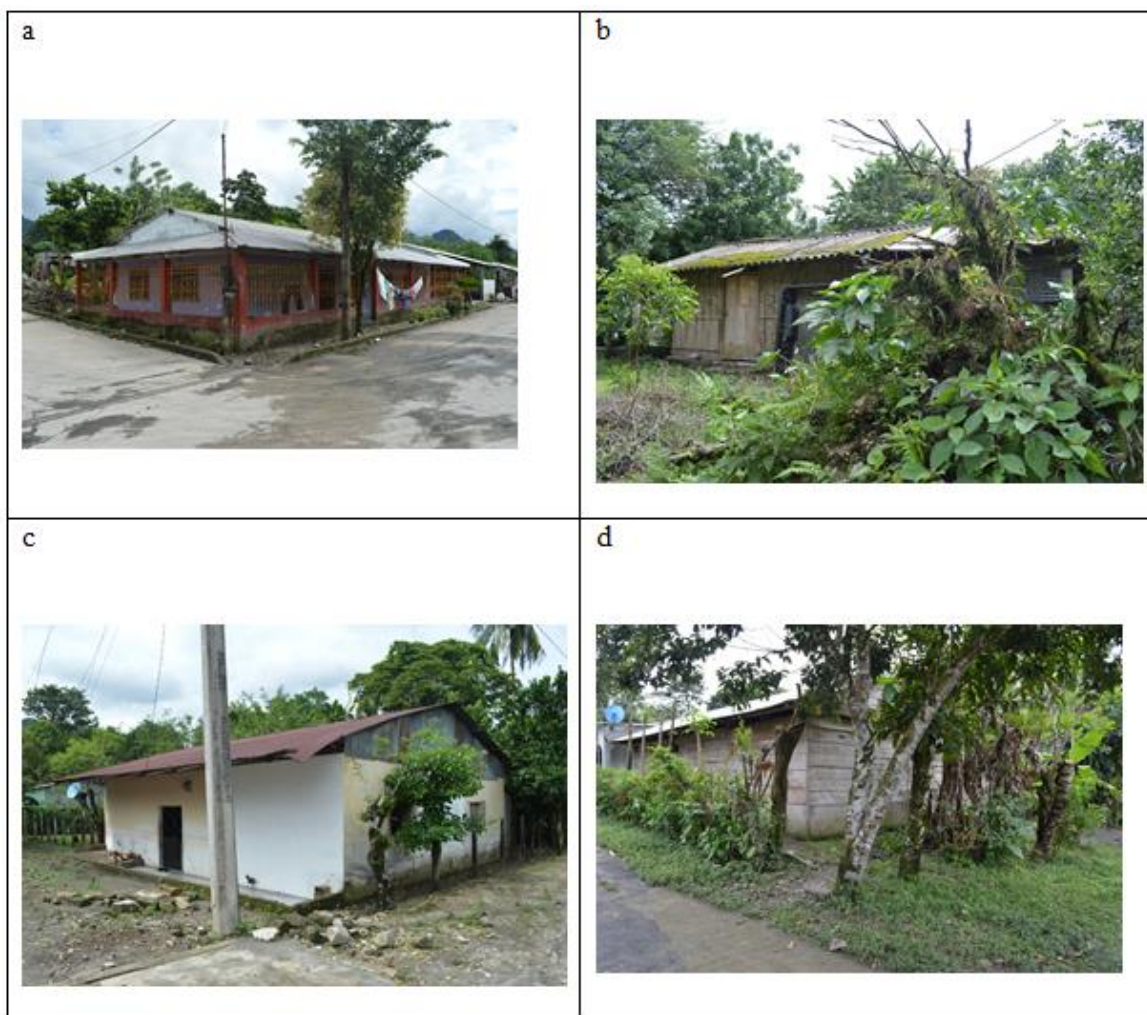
Las fotografías a y c corresponden a una construcción de concreto y lámina, las figuras b y d corresponden a una casa habitación construida de madera y caña brava.
